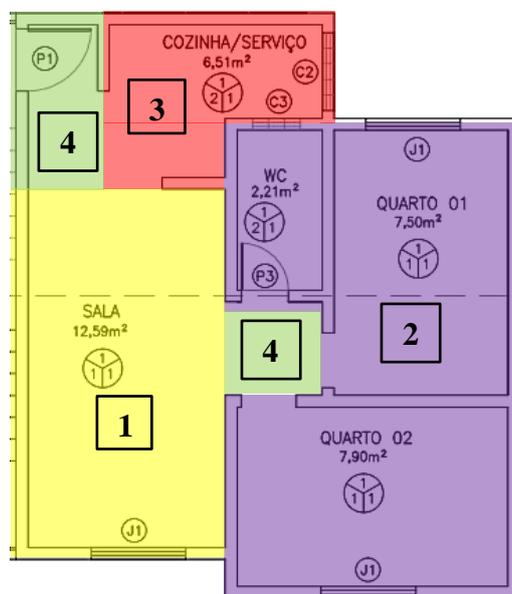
Planta Baixa do bloco tipo D2. 3º pavimento. T2 e T3.
